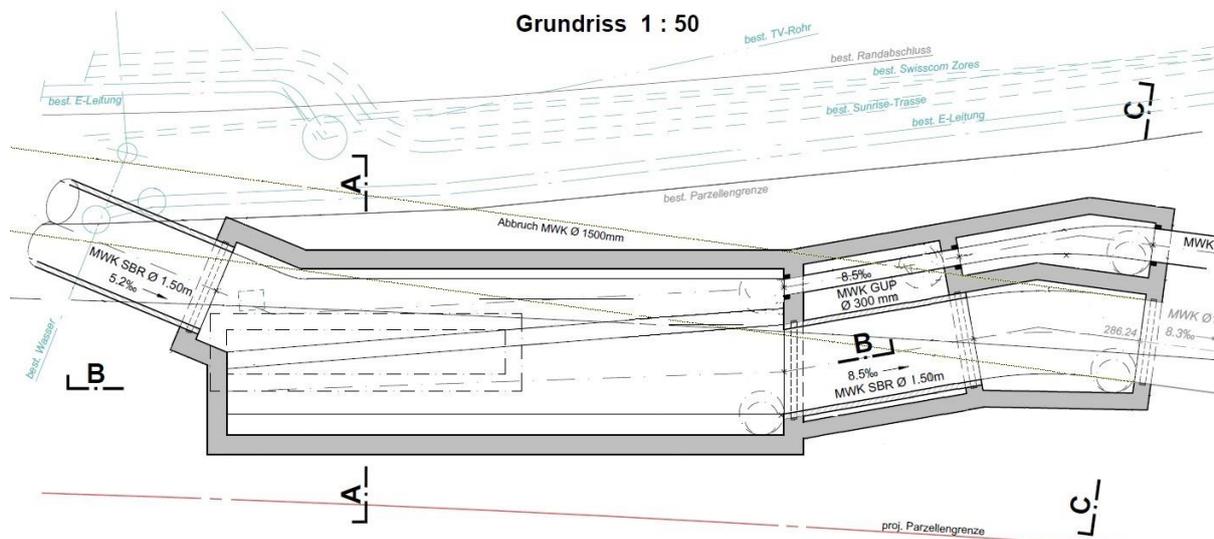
Grundriss Entlastungs- bzw. Trennbauwerk auf der Parzelle 12651 (alt 2589) in der Bruggstrasse Reinach nach Bushaltestelle.
